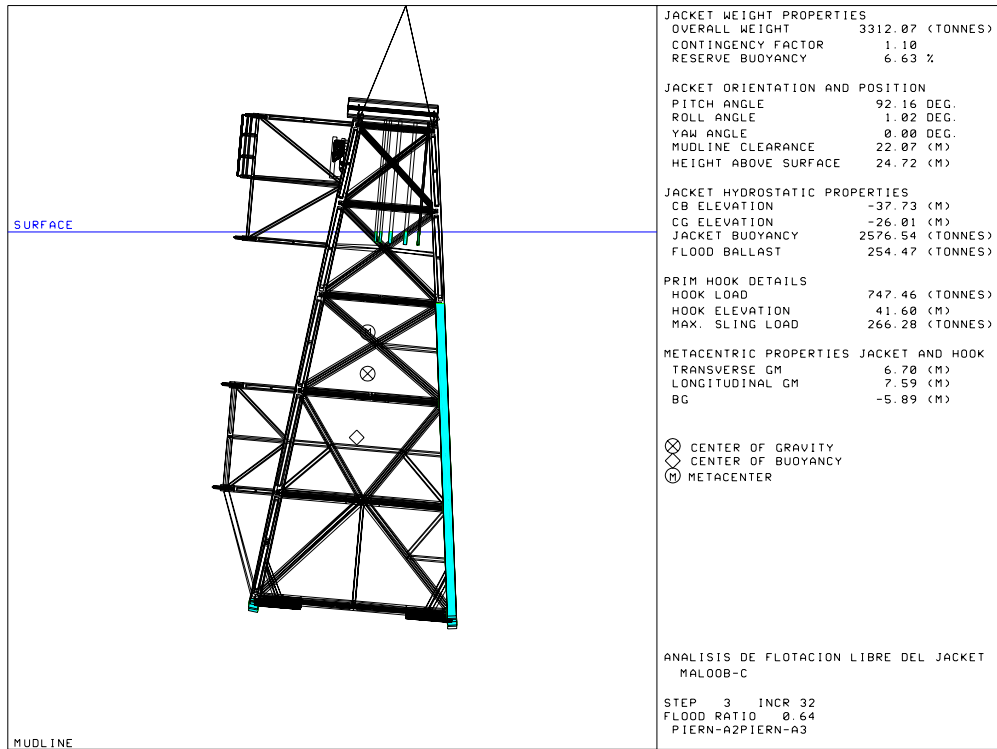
Posición de la estructura para una elevación de 41.60 m.
